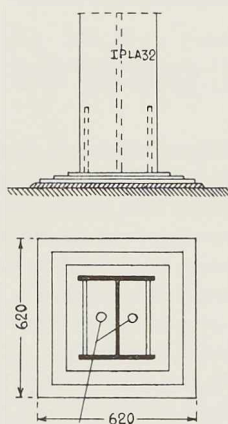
Fixation sur le béton d'une colonne intérieure.
